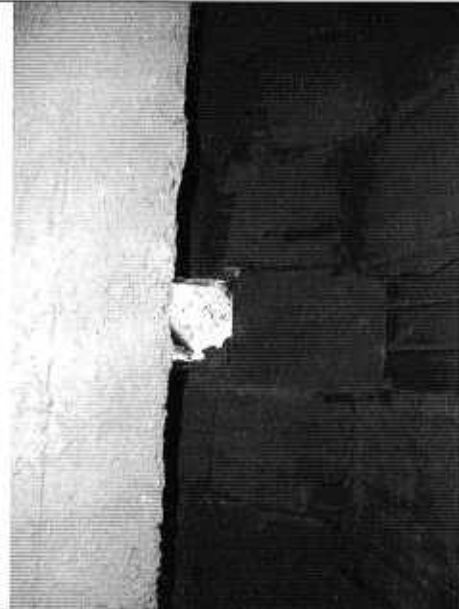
Vista interior de uno de los cascarones. La mampostería rodea a la columna (izquierda), existiendo una holgada separación entre ambos elementos.
